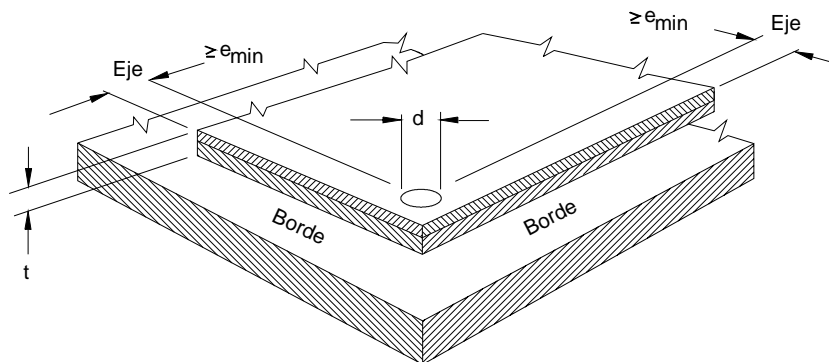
C Punto de soldadura por arco - Un solo espesor de plancha
